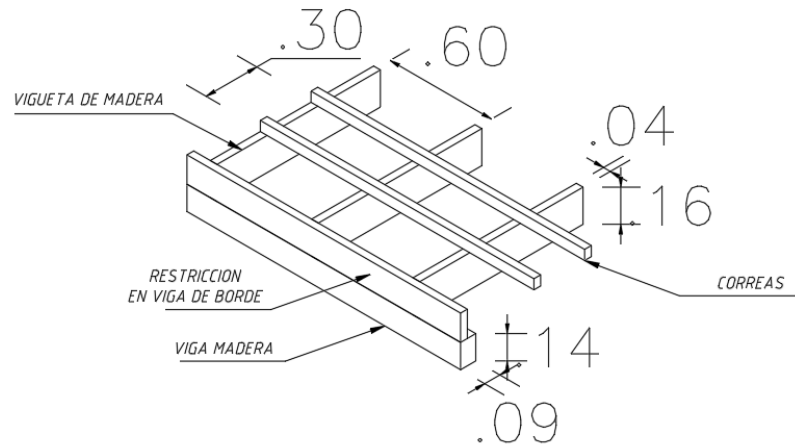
Detalle de armado de vigas y viguetas de techo
